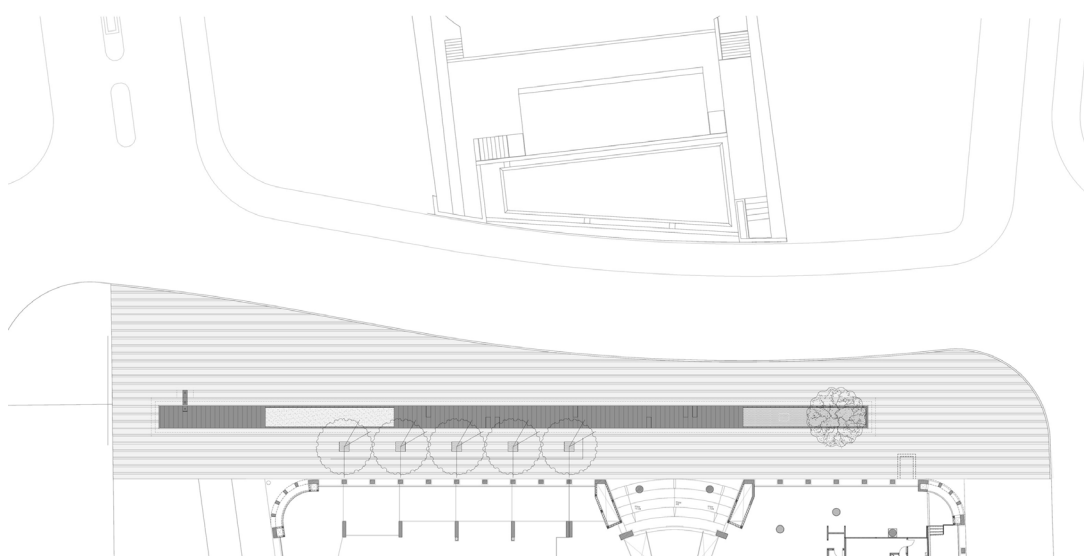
Planta de implantação do memorial Cebran Tueni
